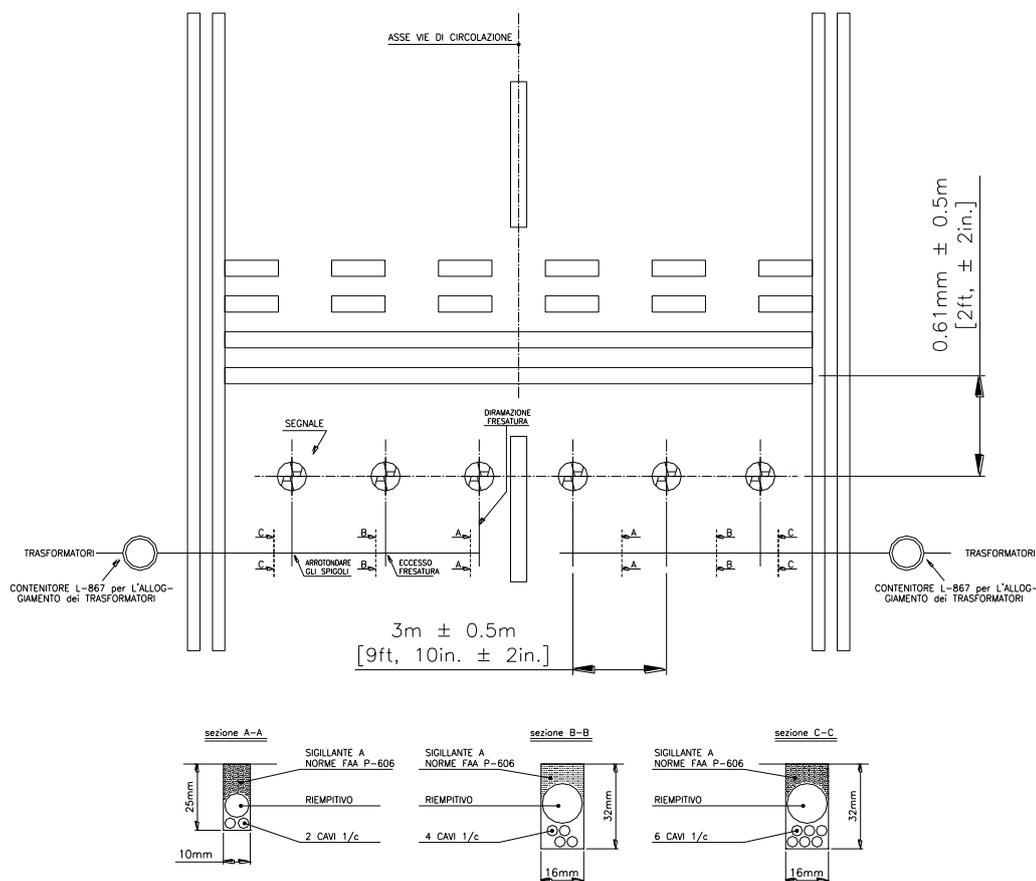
Barre d'Arresto (OACI) Schema di Disposizione dei Segnali
